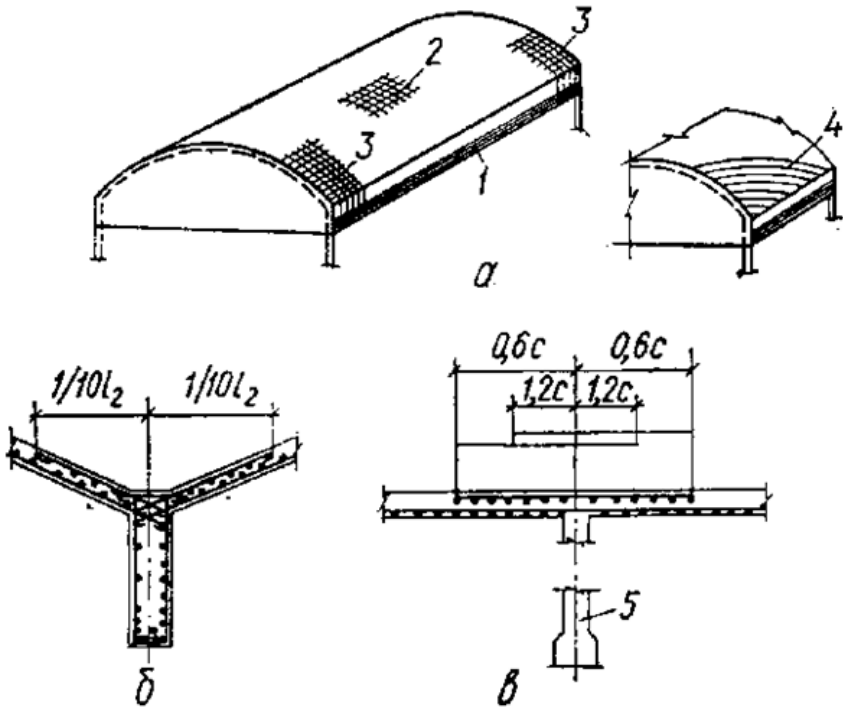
Схема армування монолітної довгої оболонки:
